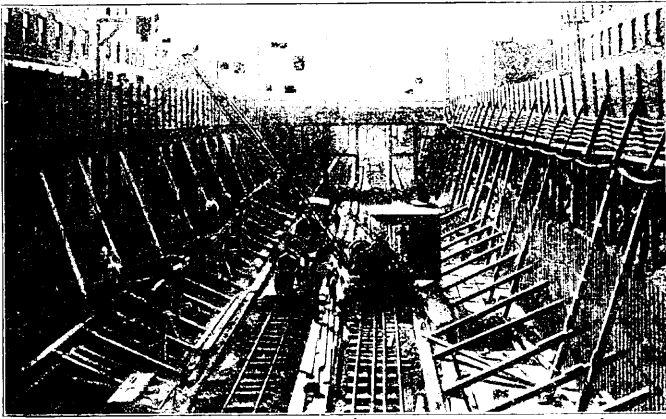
Bau der IV. Avenue-Untergrundbahn in Brooklyn. Blick in die abgesteifte Baugrube; im Hintergrunde bewegliche, eiserne Schalungsgerüste zur Betonierung des Tunnels.
